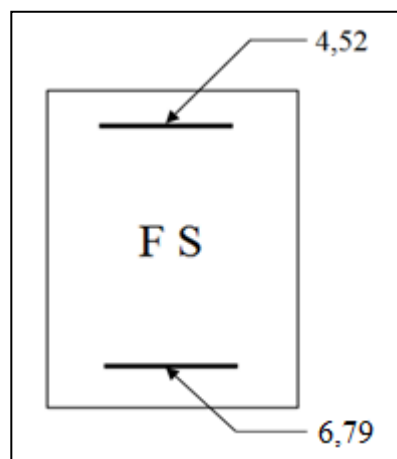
Section d'armatures de la poutre palière calculée à la flexion simple
